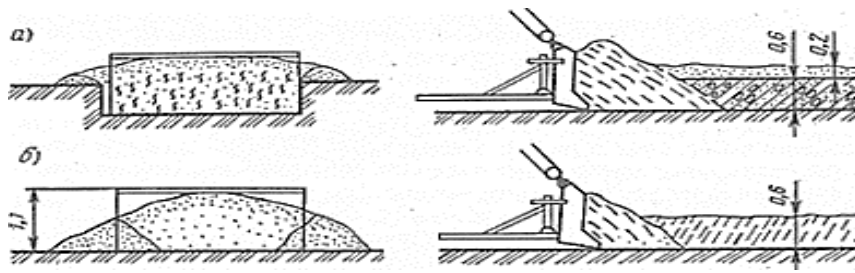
Схемы перемещения грунта бульдозерами по траншеям
